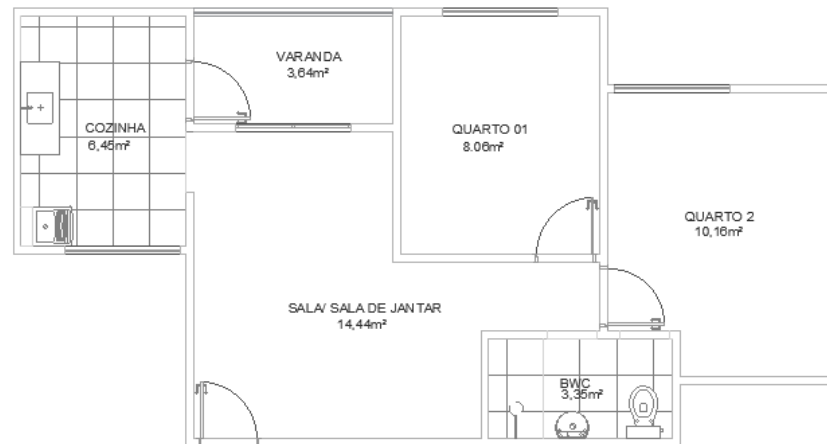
Planta baixa de casas geminadas do Empreendimento A
